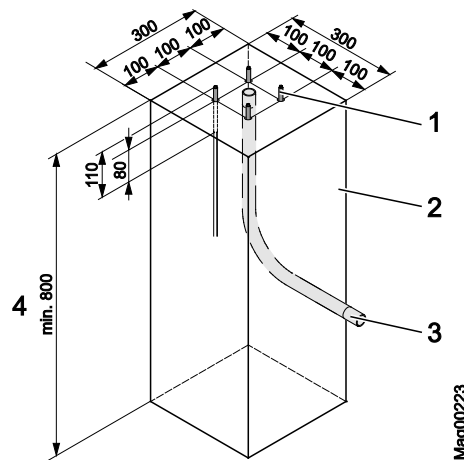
Fundamentplan Auflagepfosten und Lichtschrankenpfosten
